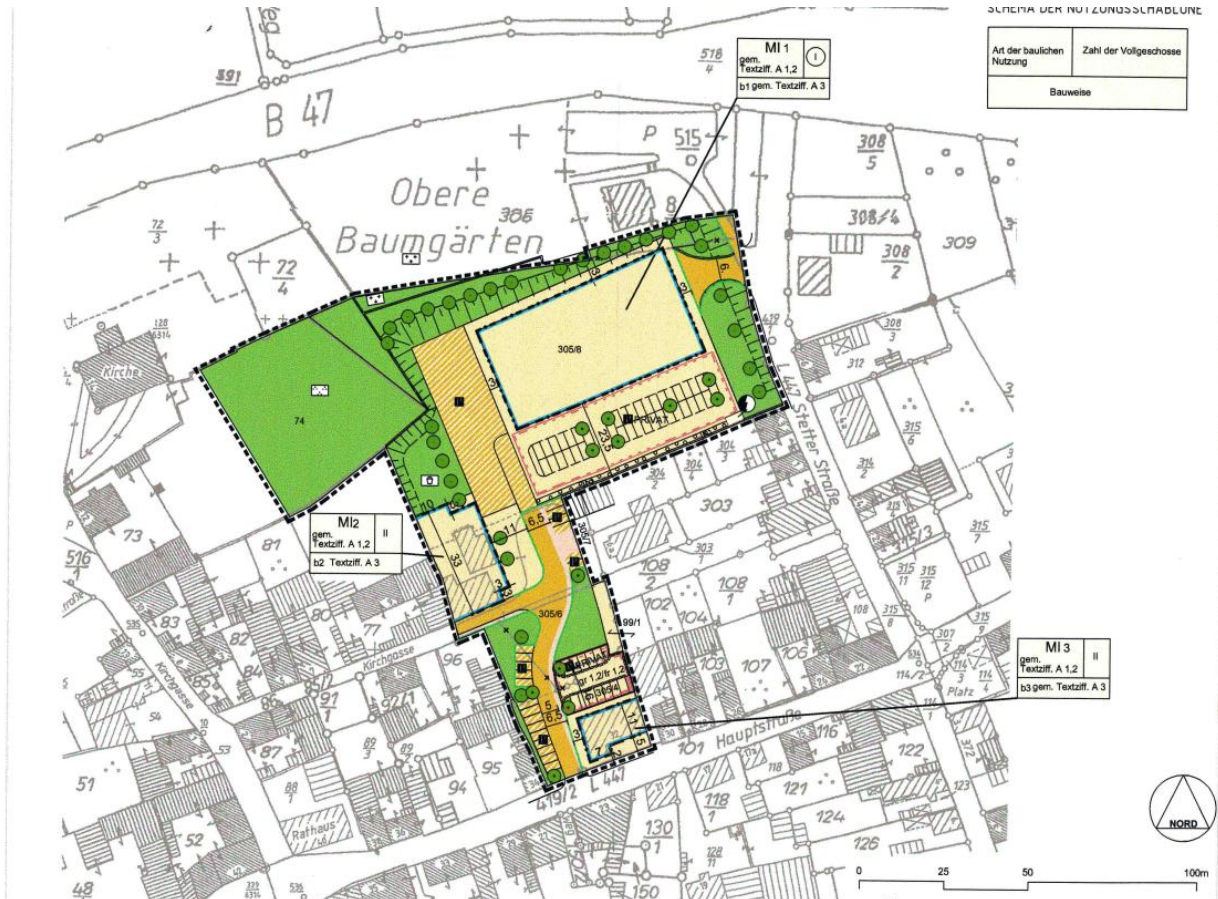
rechtskräftiger Bebauungsplan "Ortsmitte"
